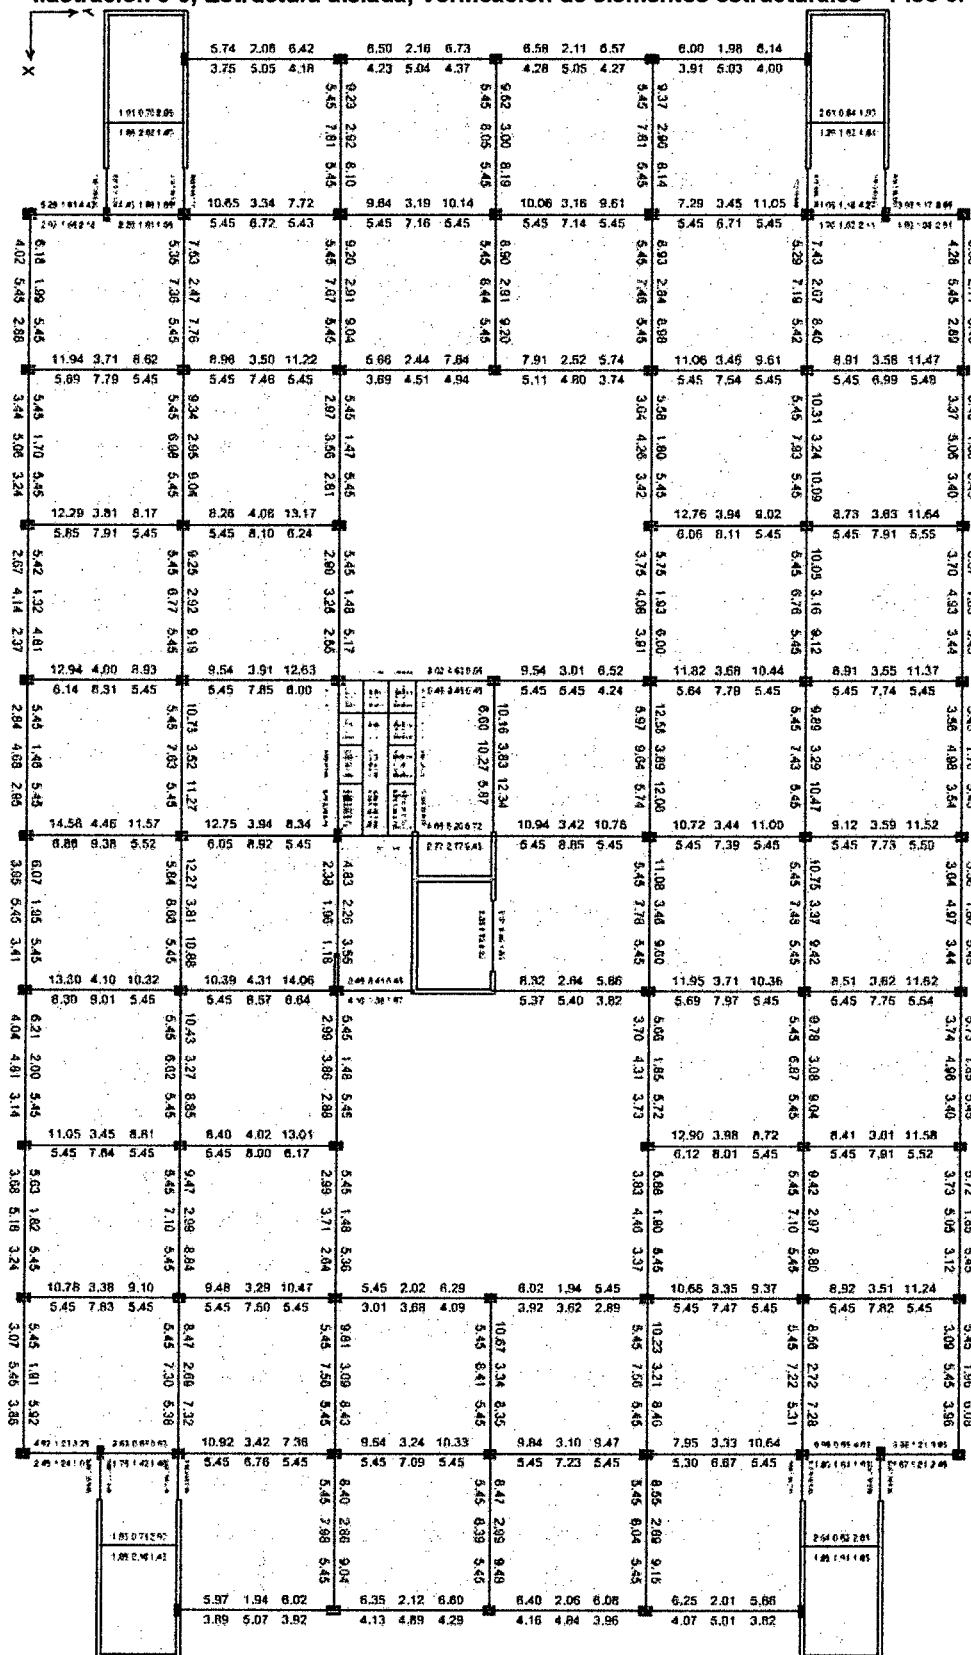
, Estructura aislada, Verificación de elementos estructurales – Piso 2.
